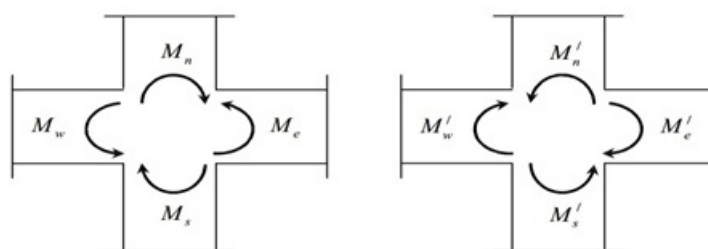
Dimensionnement d'un nœud poteau-poutre
